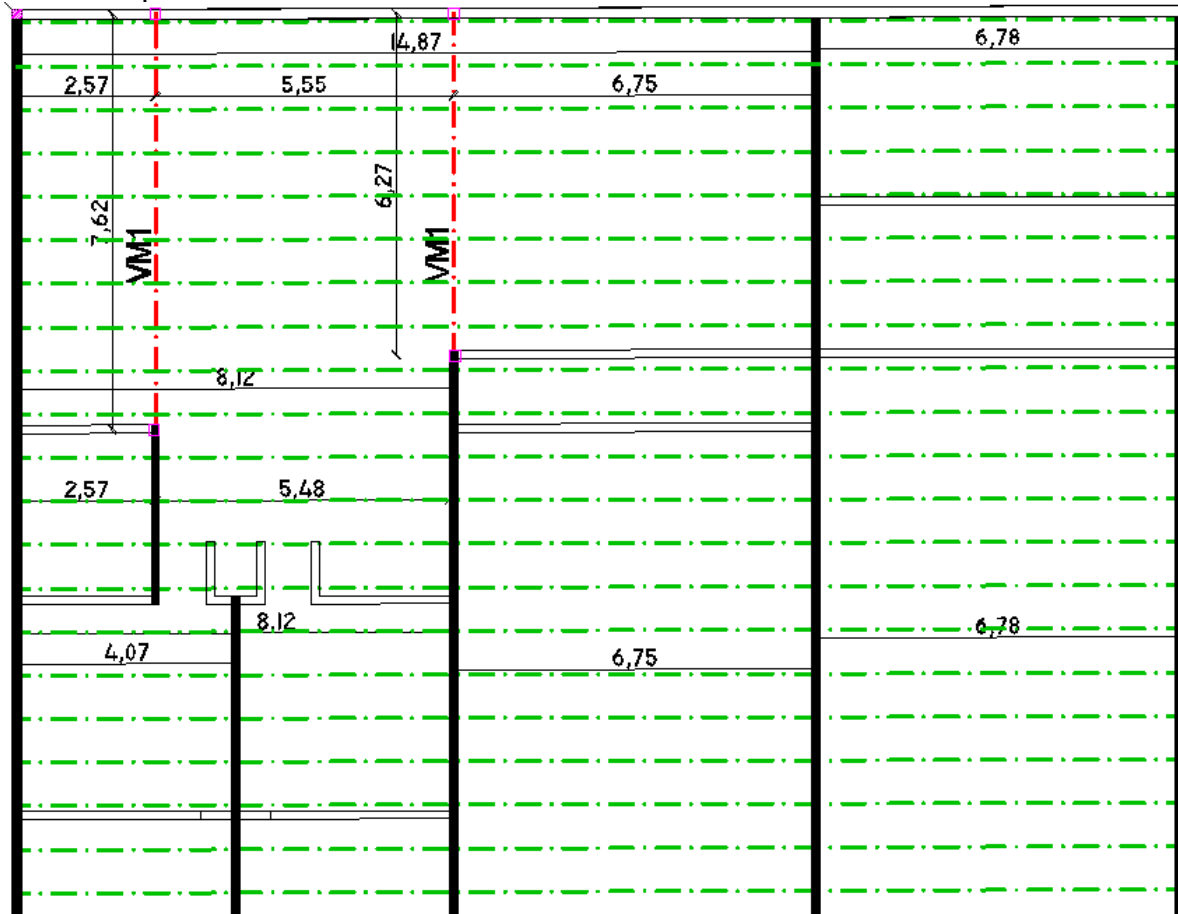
Propuesta estructural Edificio complementario (fuente: elaboración propia).
